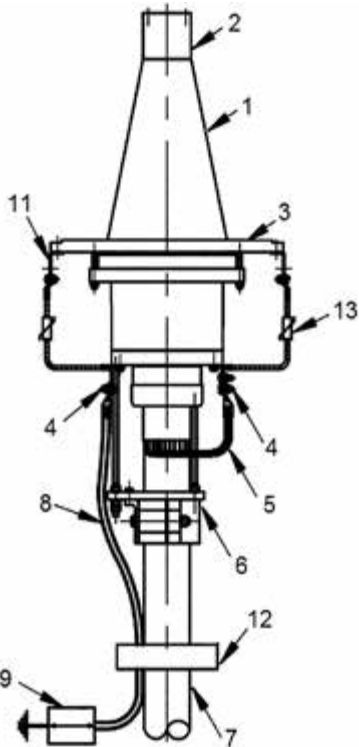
Прямое заземление вывода экрана кабеля на контур заземления с соединением ВЧ-заземлениями с ОПН вч металлического корпуса КРУЭ и металлической части кабельного ввода с присоединёнными проволоками экрана. Имеется трансформатор тока. ОПН вч с напряжением срабатывания U_c (ОПН вч) $\geq 0,4$ кВ
